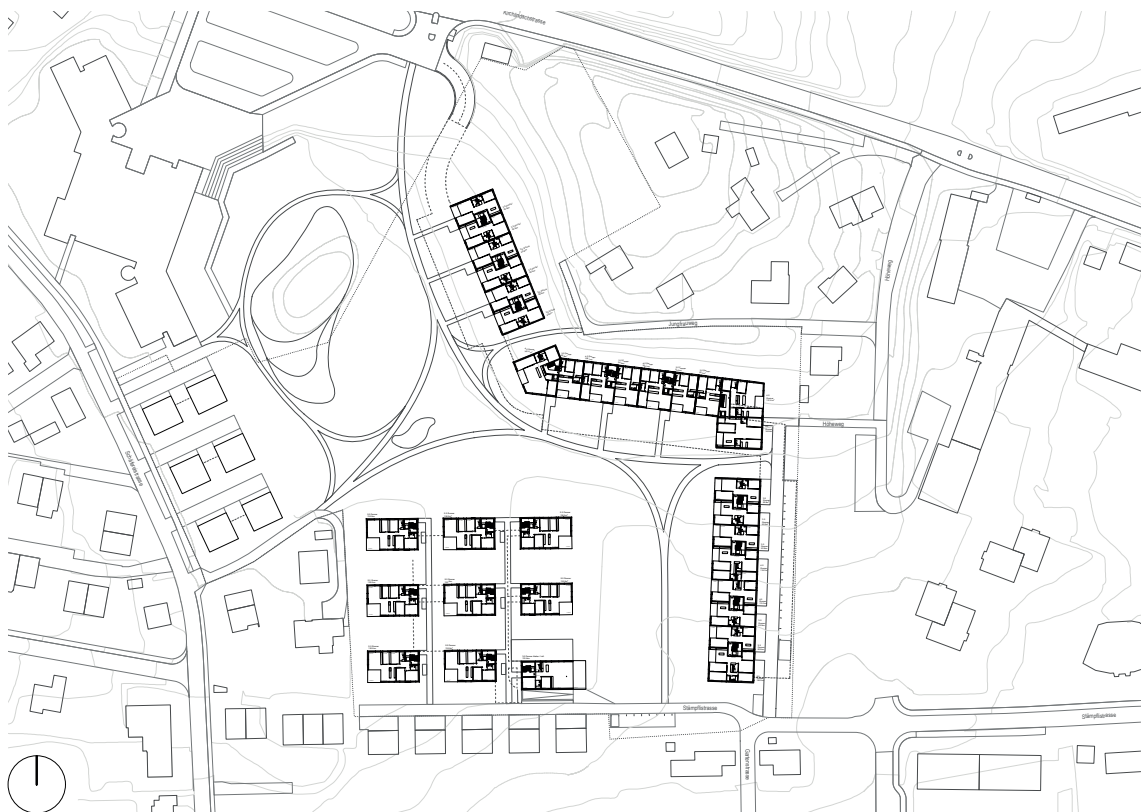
Richtprojekt – Grundrisse Obergeschoss
